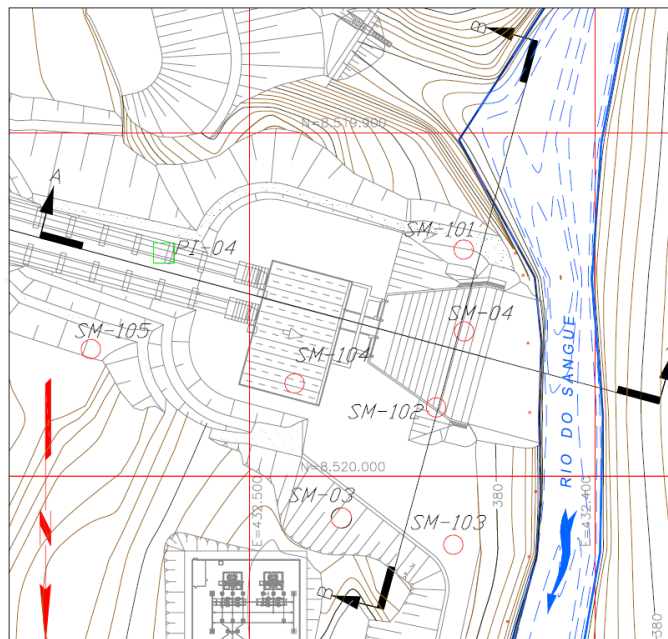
Sondagens geotécnicas para construção da casa de força (Corrêa, 2006).
